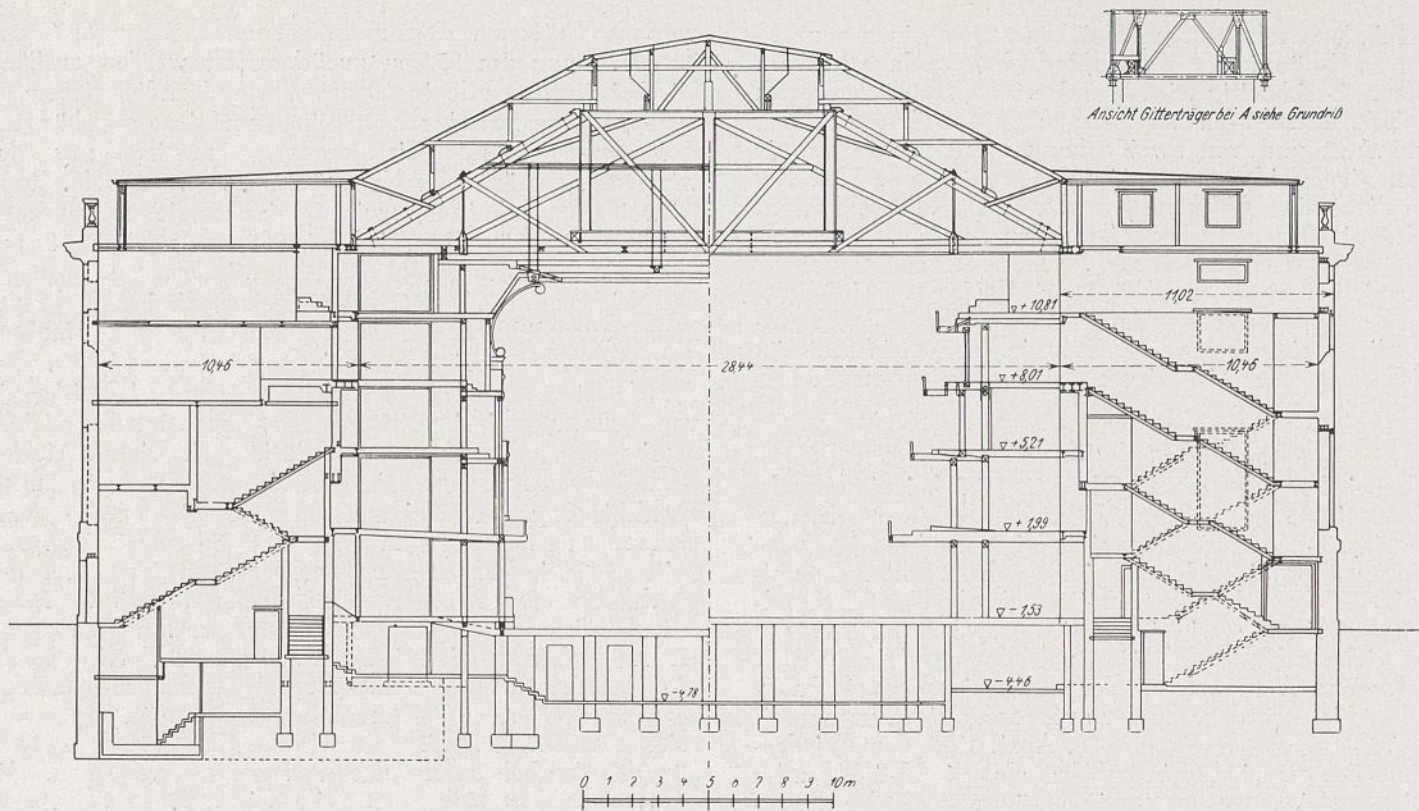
Eisenkonstruktion des Zuschauerhauses, Längsschnitt.
